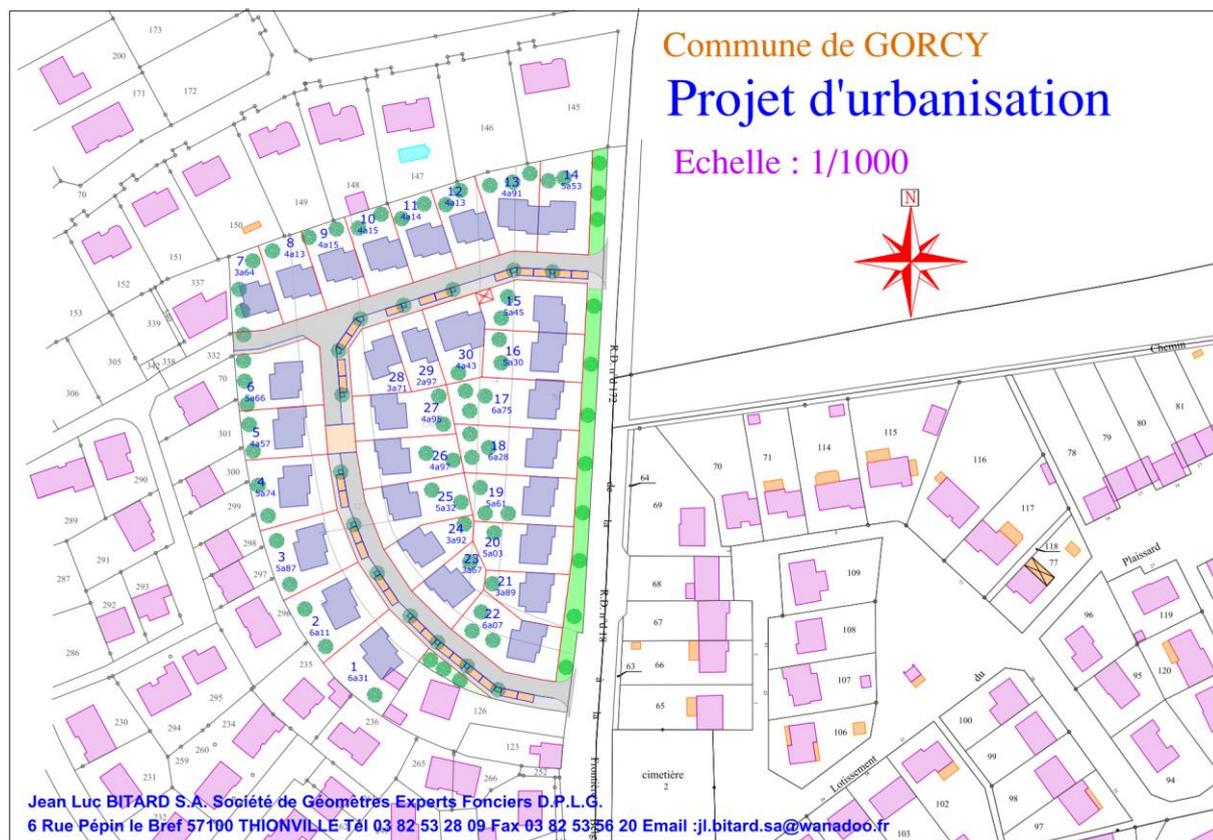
Plan de masse projet : surface plancher créée estimée à 15.000m²
